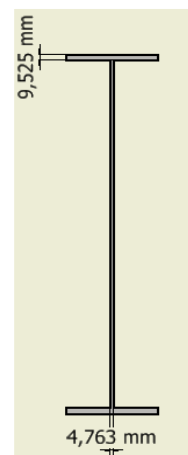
Sección transversal de la viga en acero ASTM A 36 y Domex 700
